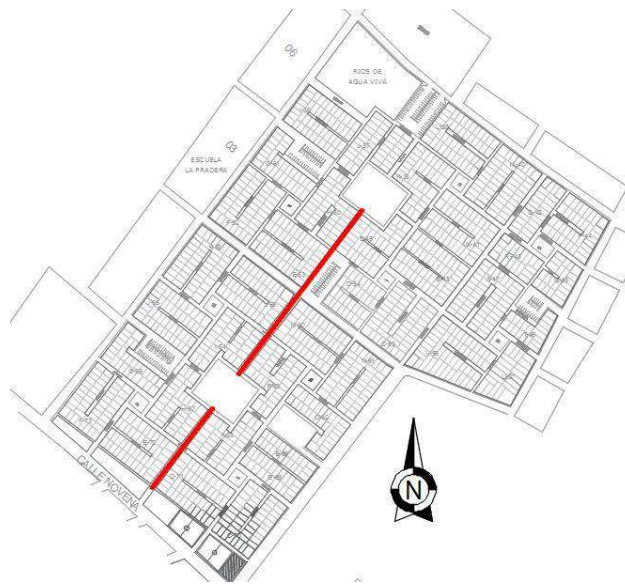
Implantación de cubiertas en plazoleta tipo
